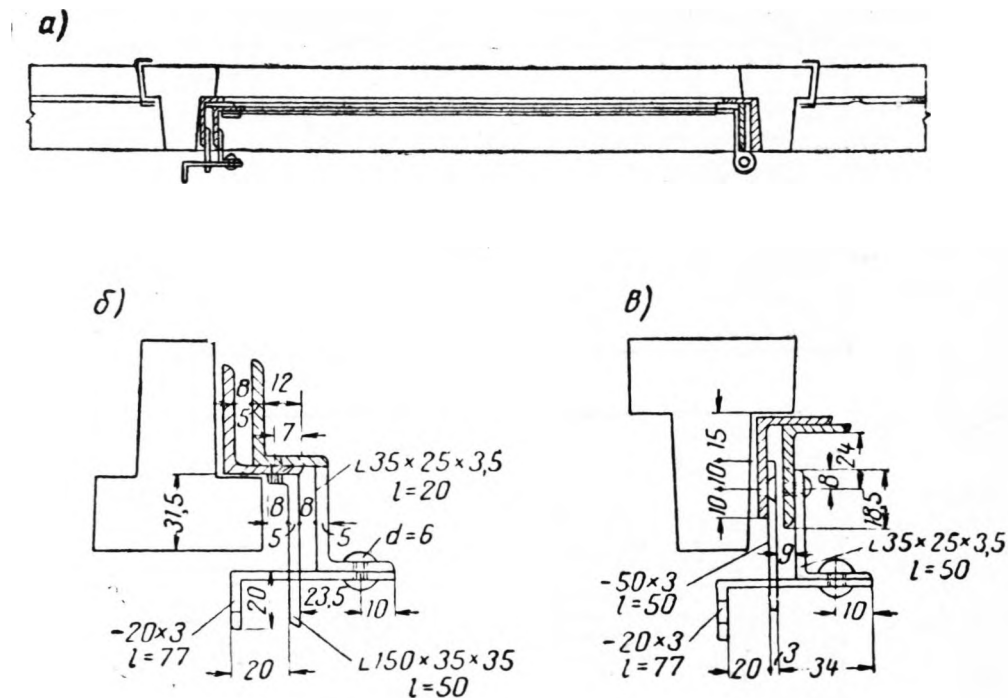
Детали устройства открывающихся створок железобетонных переплетов
